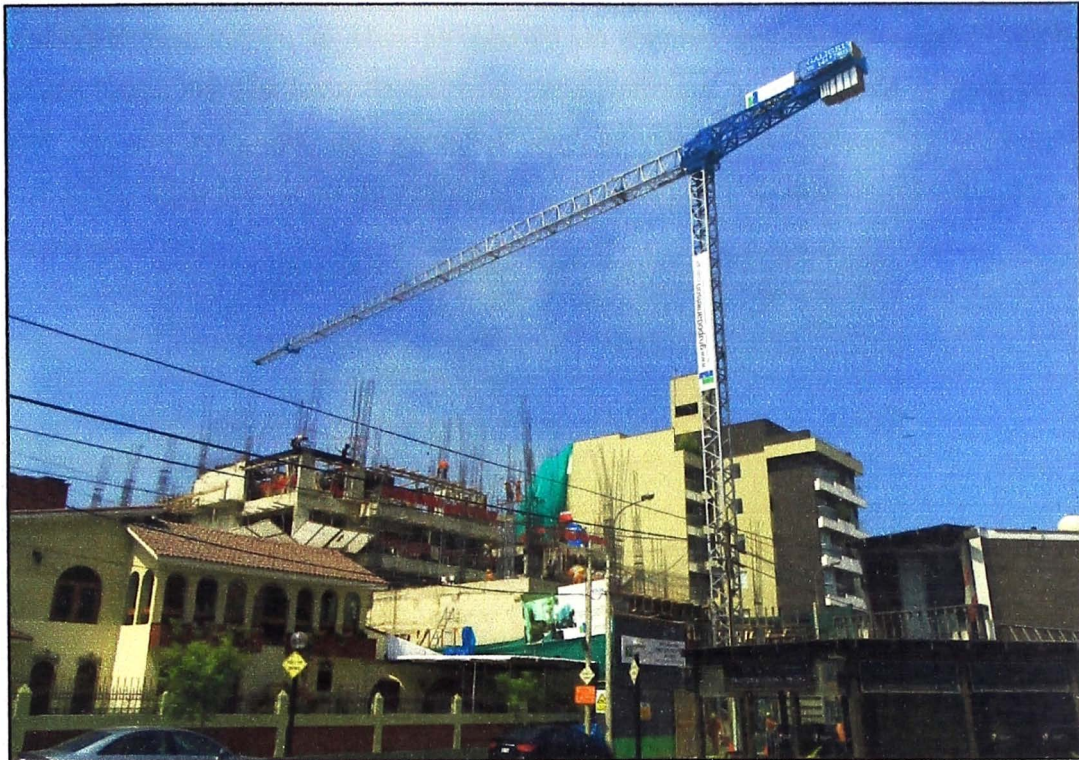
Vista de la grúa torre instalada en el frontis de la obra.
